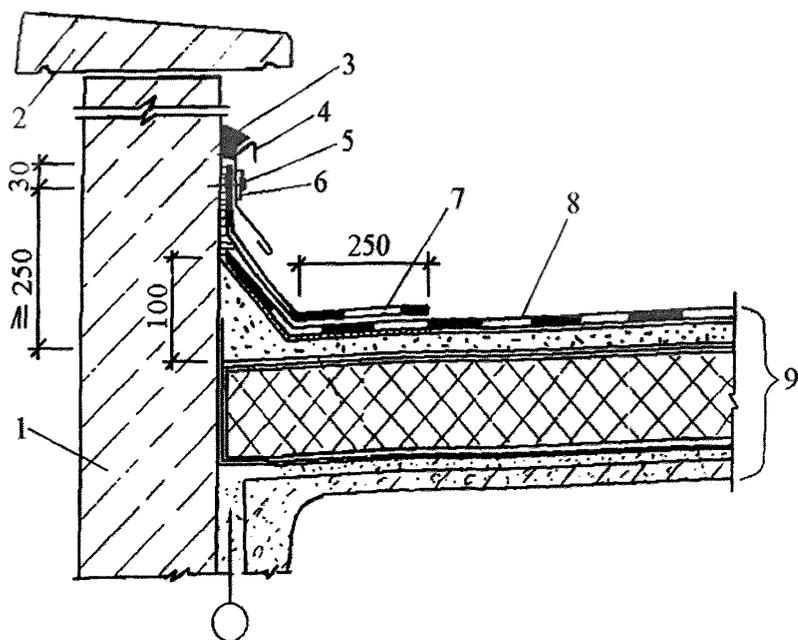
Пример примыкания водоизоляционного ковра к бетонной стене высотой более 450 мм:
